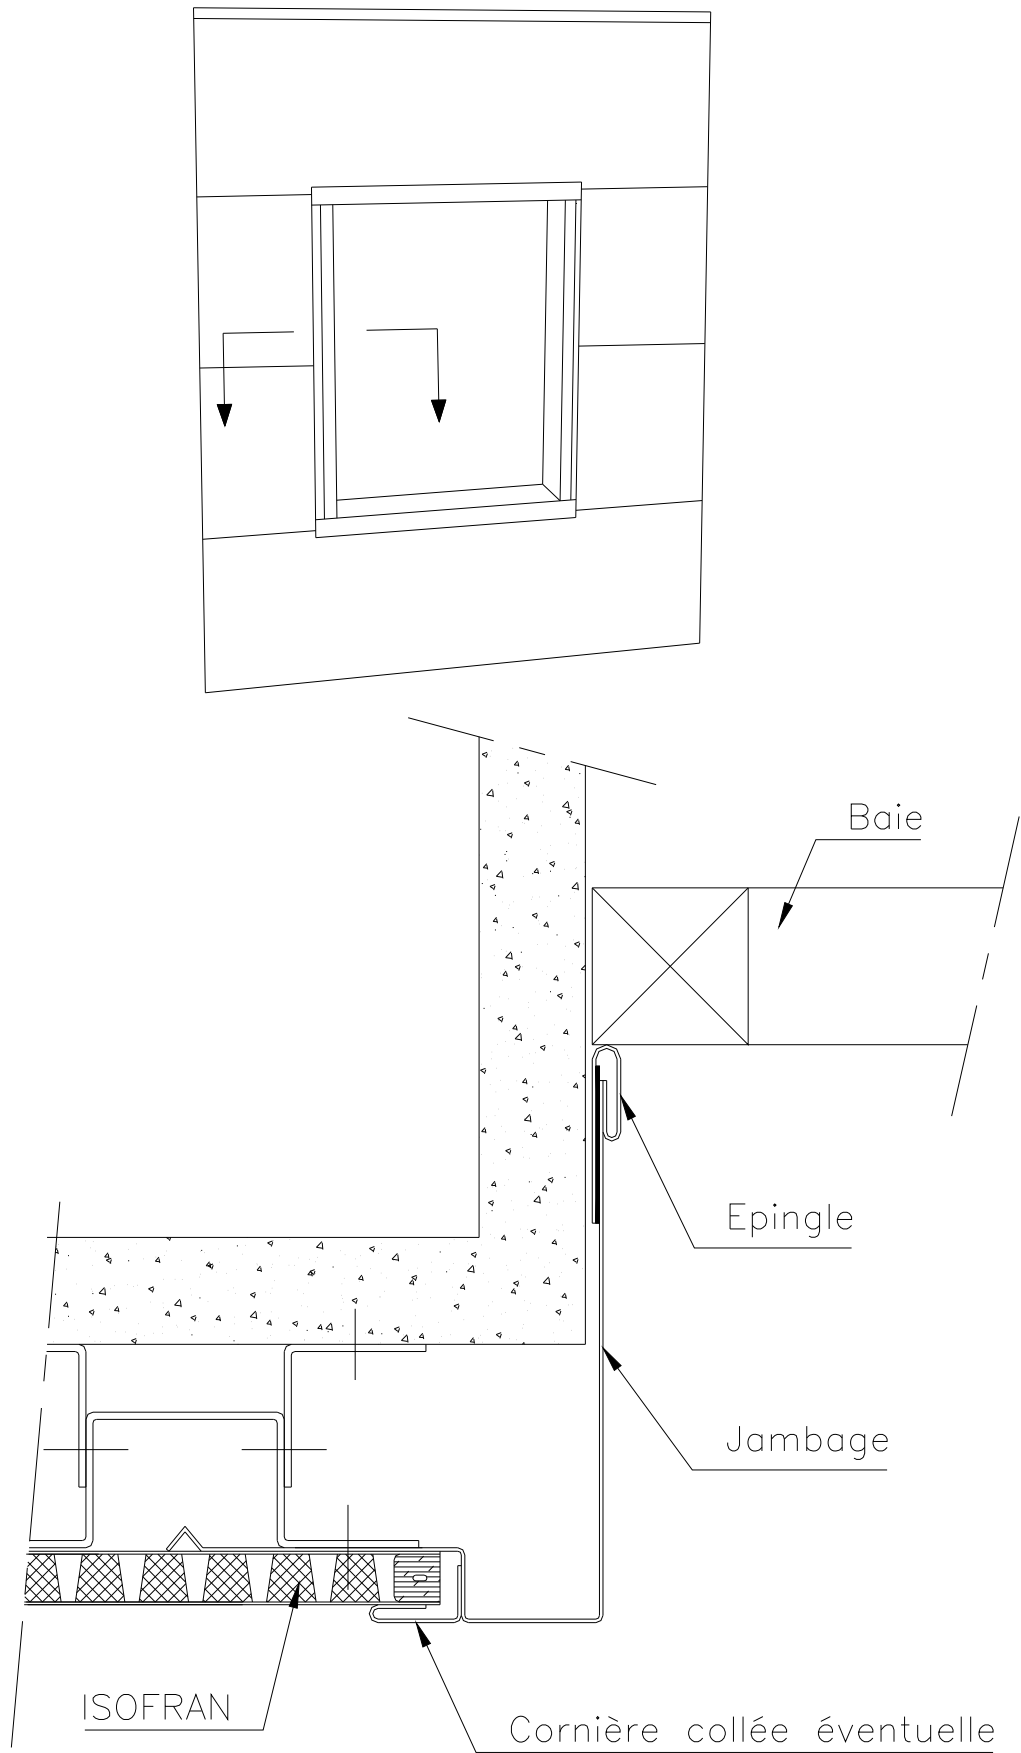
Panneau ISOFRAN Pose horizontale - tableau
